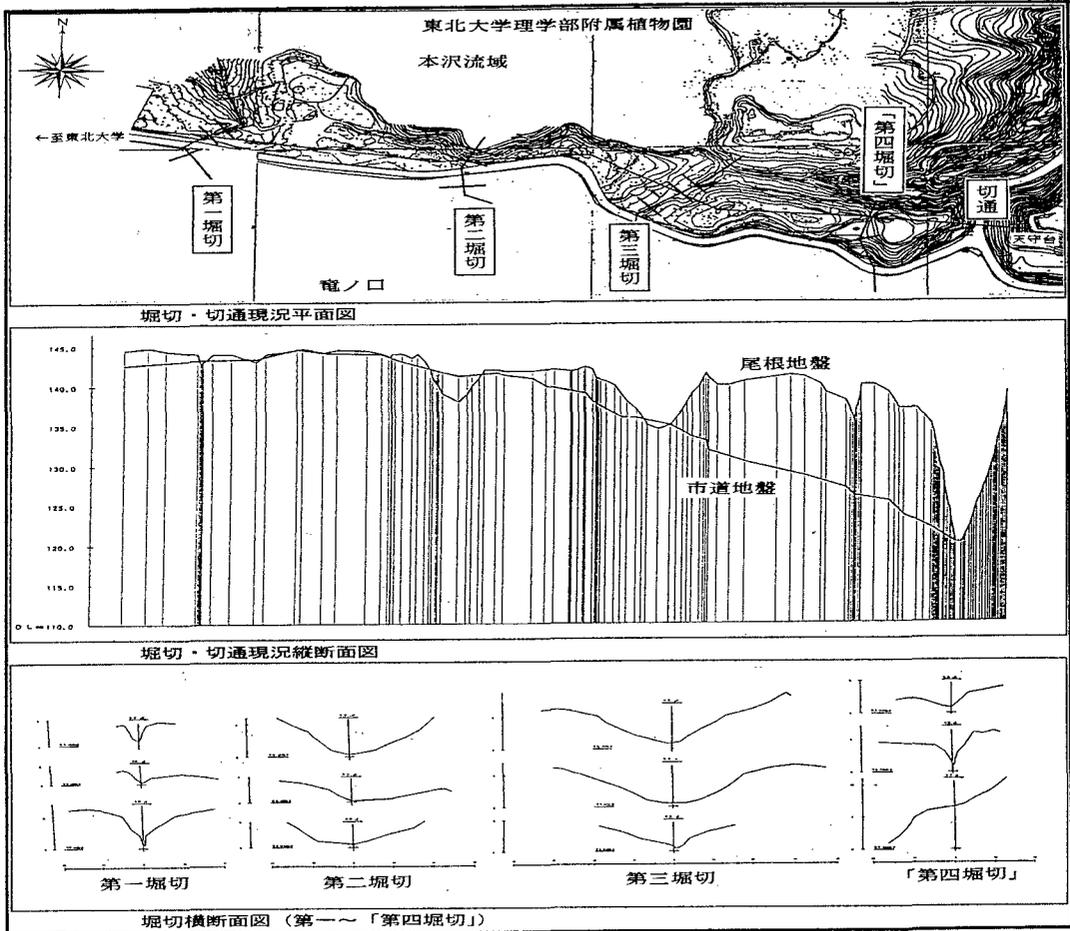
堀切・切通 (上段：平面図・中段：縦断面図・下段：横断面図) 位置図 縮尺1/250 変倍縮小
